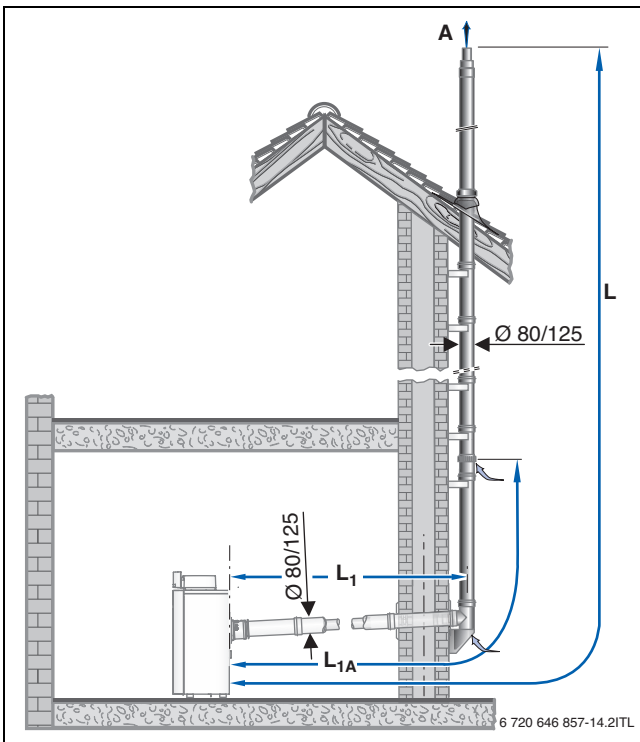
Variantes de montaje con el kit de montaje GAF-K
